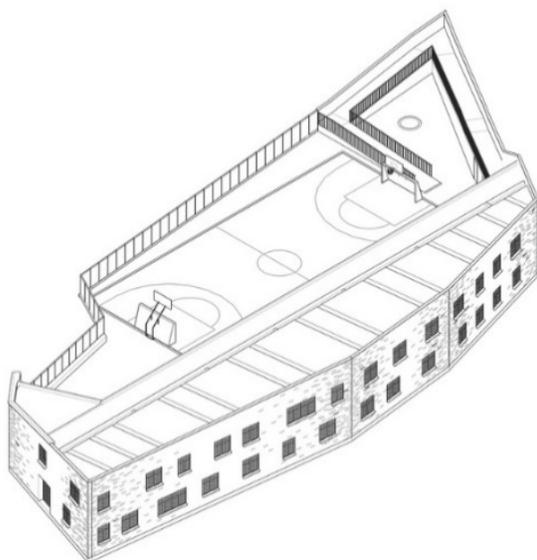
/ Institución Rural Chaparral/ Obtenido de Plan B Arquitectos
